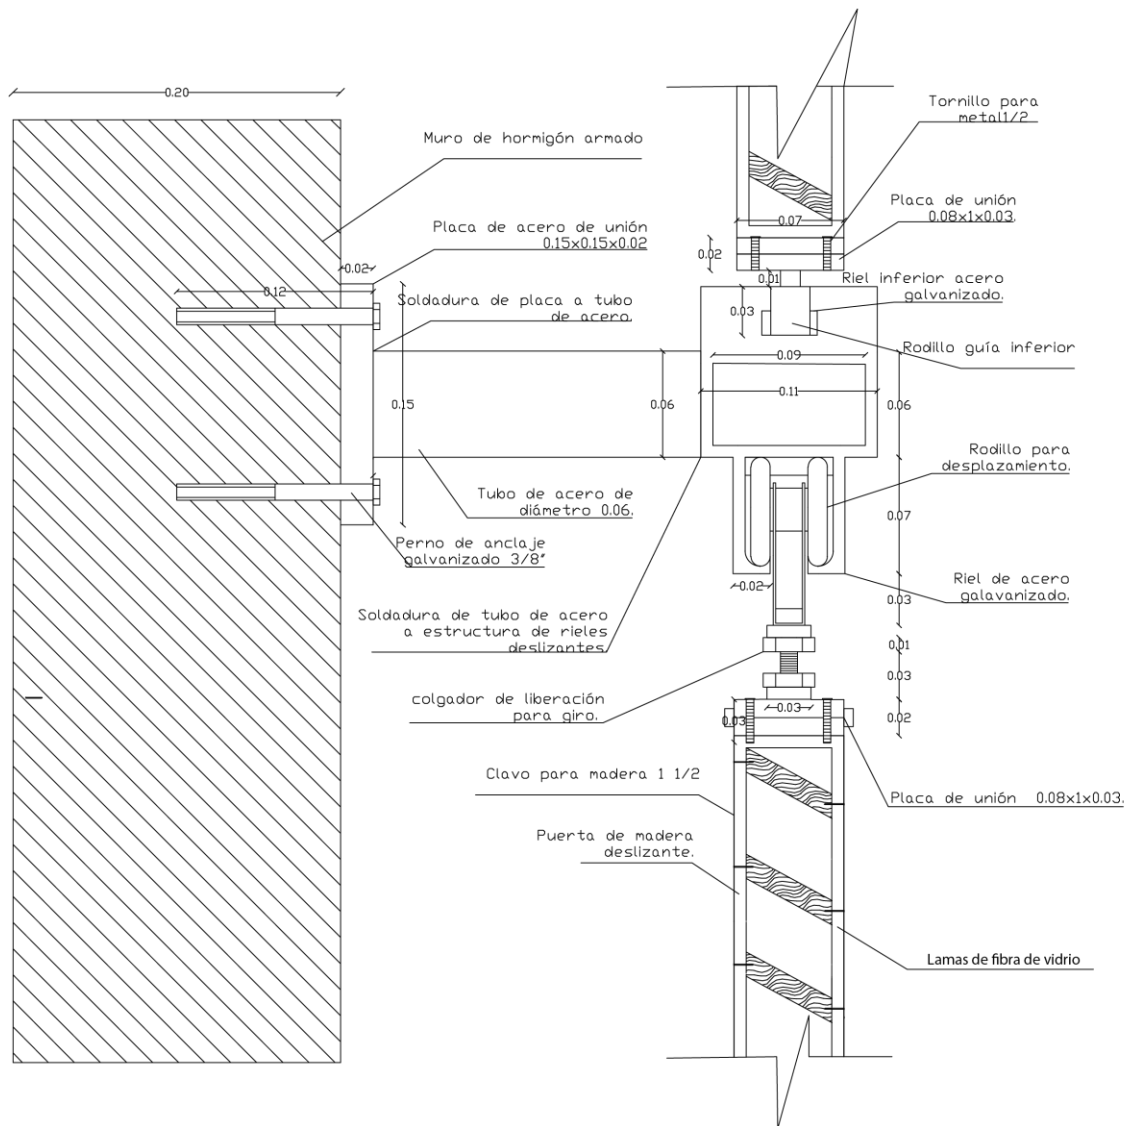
Detalle constructivo de anclaje de estructura desmontable y rieles deslizantes s/e
